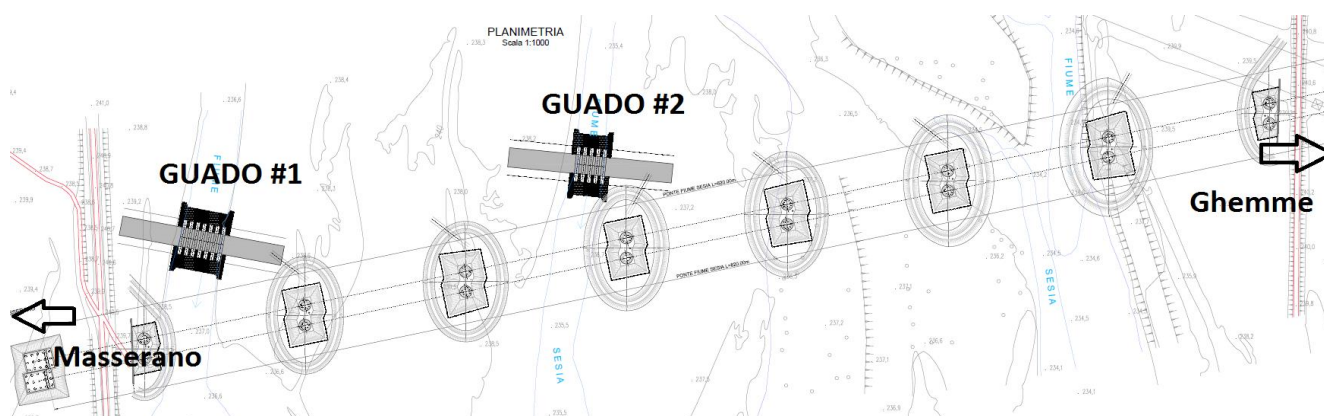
Vista in planimetria degli attraversamenti provvisionali
